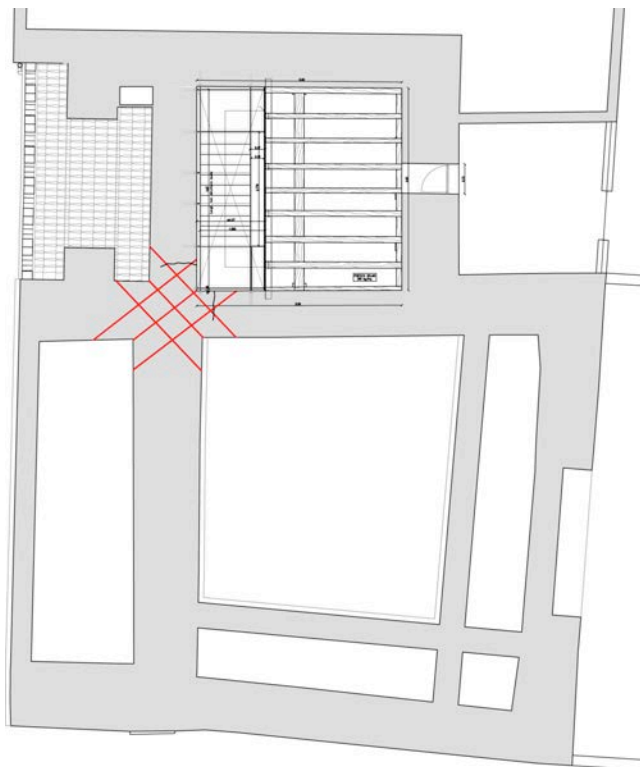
Pianta quota +6.00m. Posizione connettori di ancoraggio.
